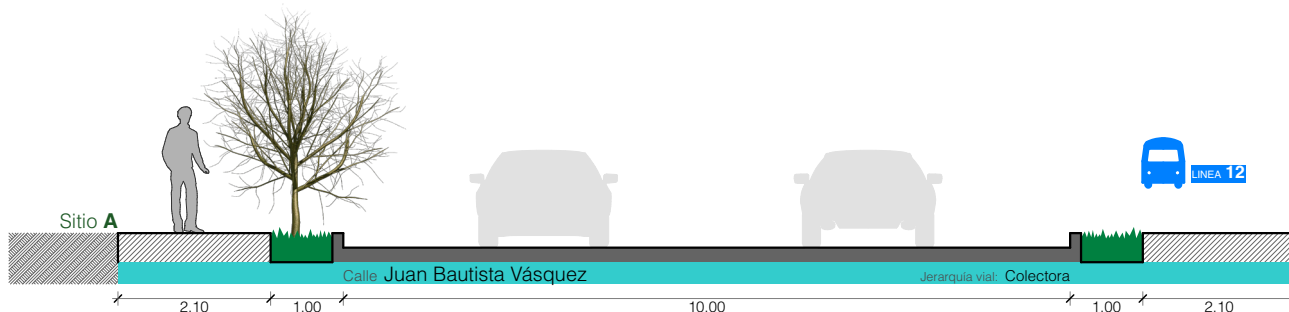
\_ Sección de la calle Juan Bautista Vásquez
